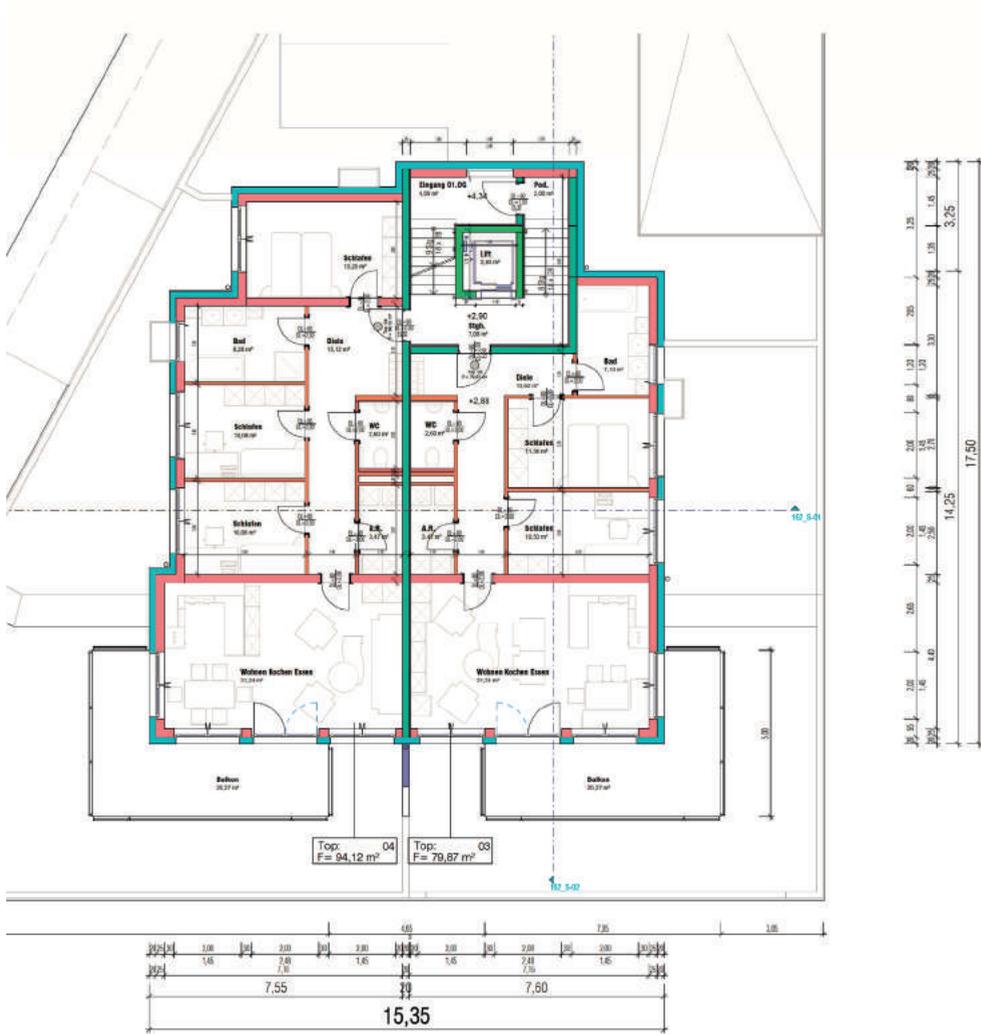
Projekt „Wohnen im Grünen“ – Grundriss 01 OG [18]
